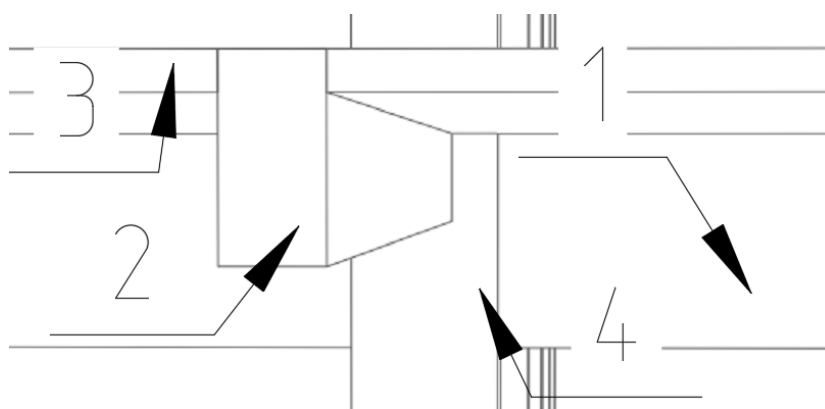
Фрагмент конструктивной модели второго варианта (1 - главная балка, 2 - второстепенная балка, 3 – плита перекрытия, 4 - колонна)
